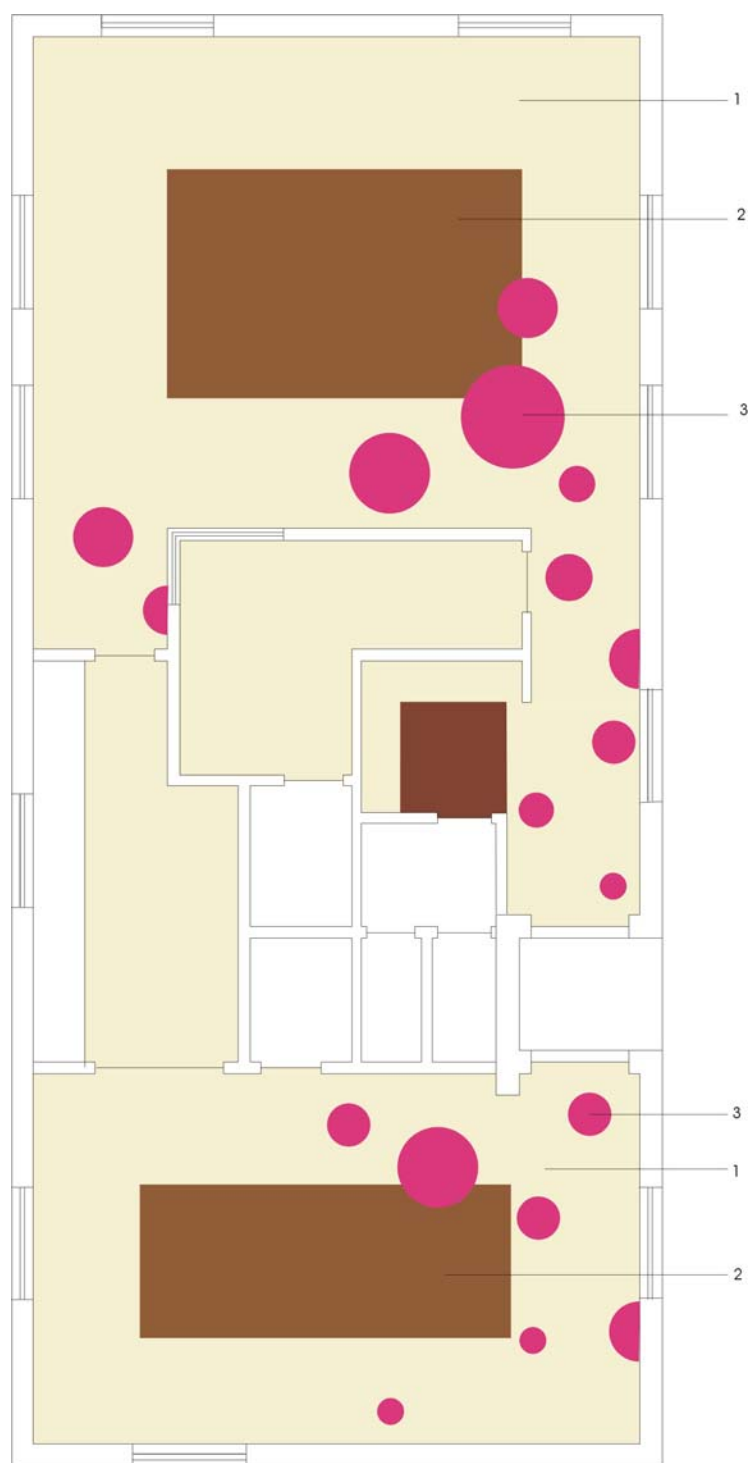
Planta do Jardim-de-Infância de Venade – Proposta de Pavimento (ver Quadro 3.3)
